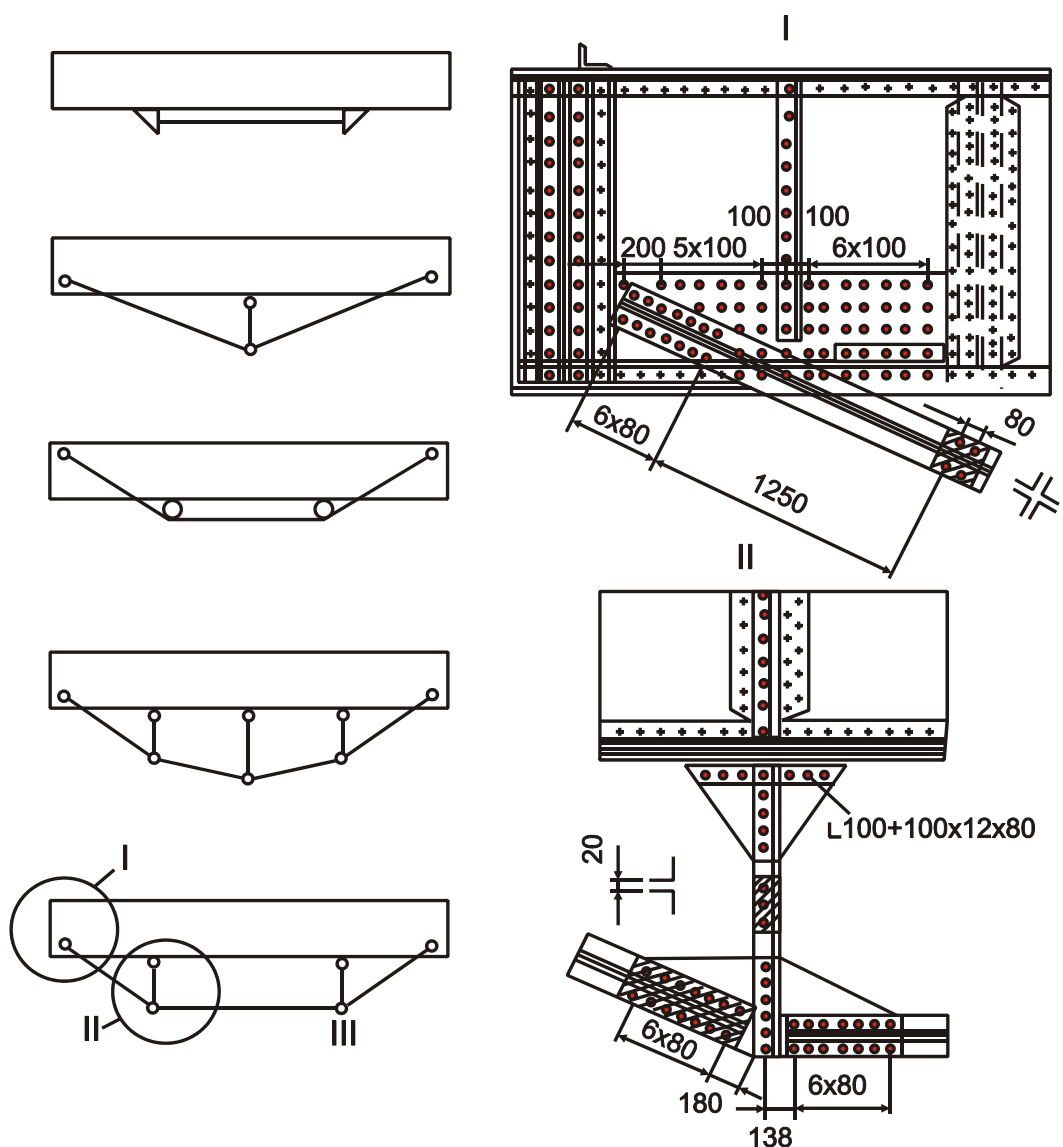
Схемы усиления металлических балок шпренгелями
